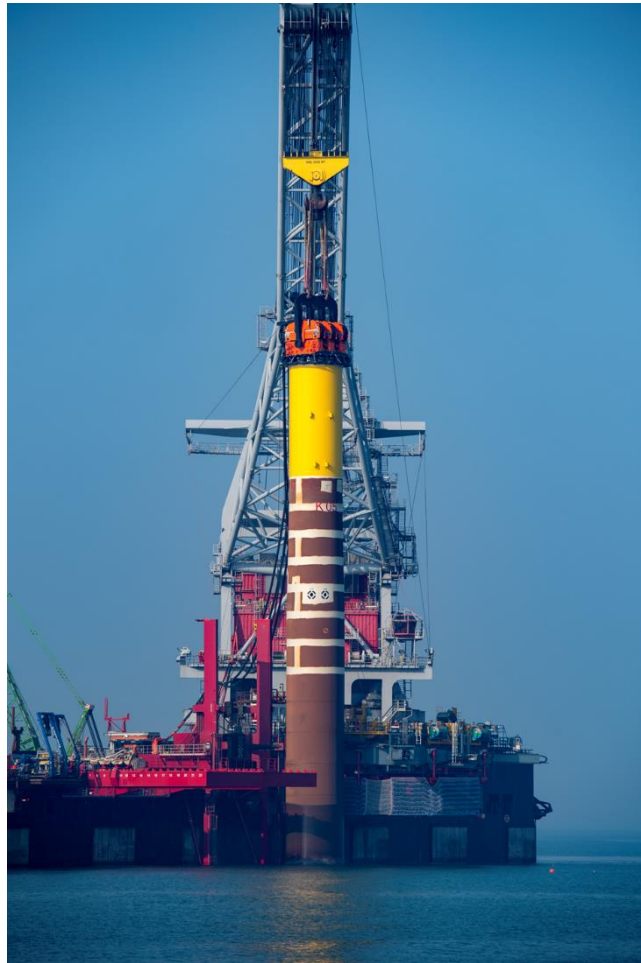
Overgangselement placeret på en sænket monopæl (foto fra RWE's egne ressourcer)
